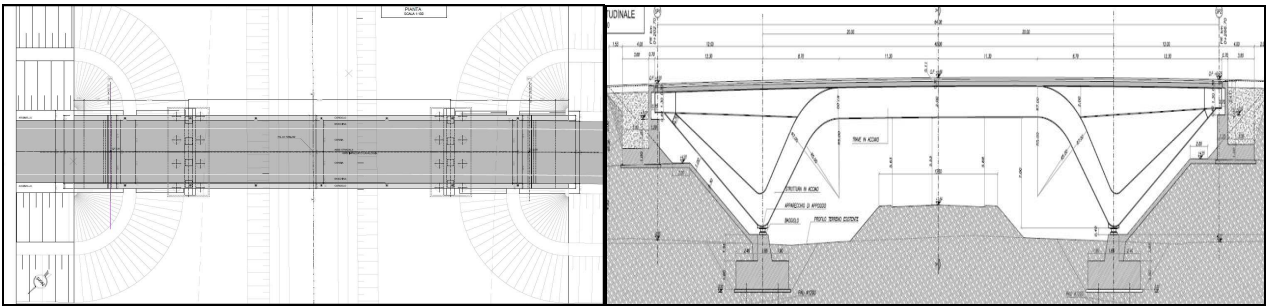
Pianta e Sezione longitudinale Cavalcavia di svincolo al Km 7+299,29
